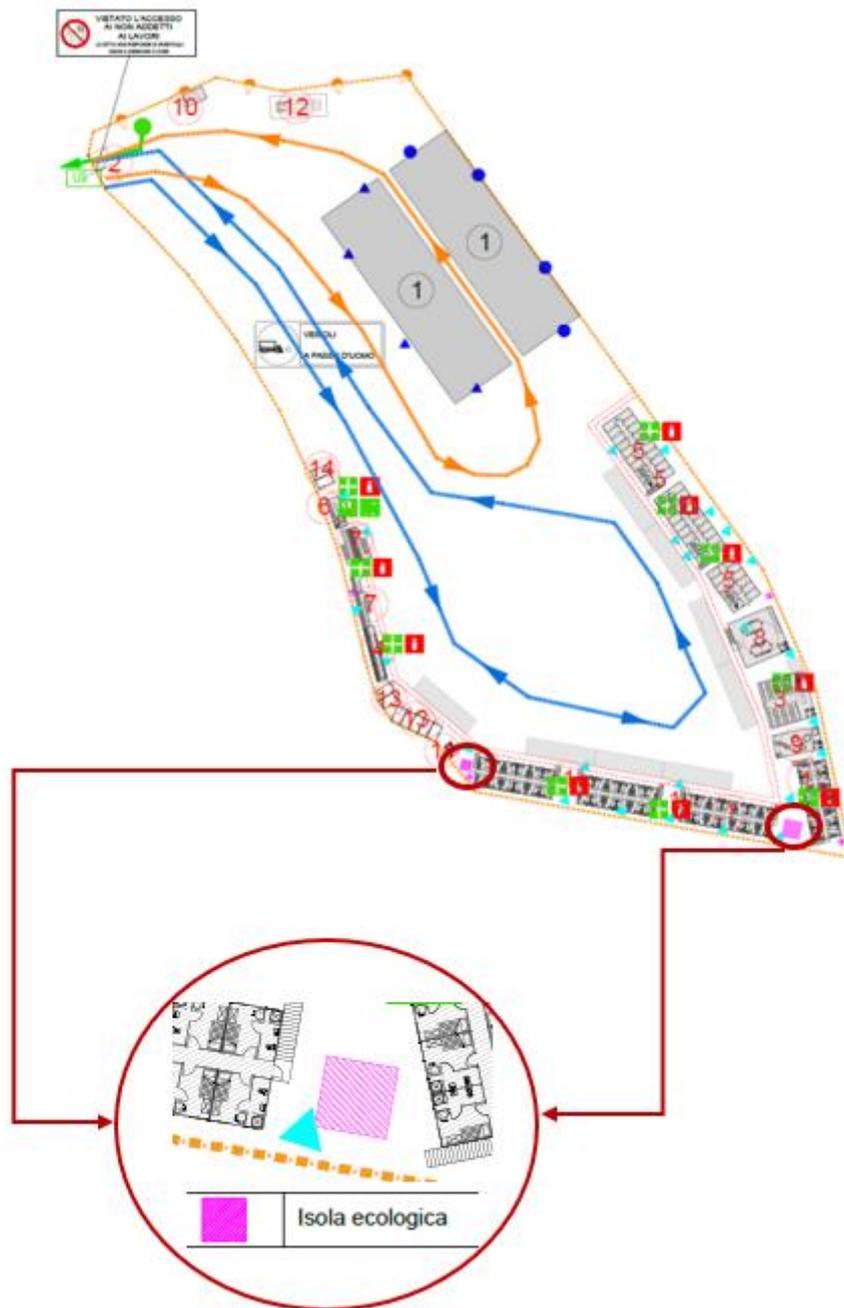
Cantiere base C.B3_Ubicazione depositi temporanei
